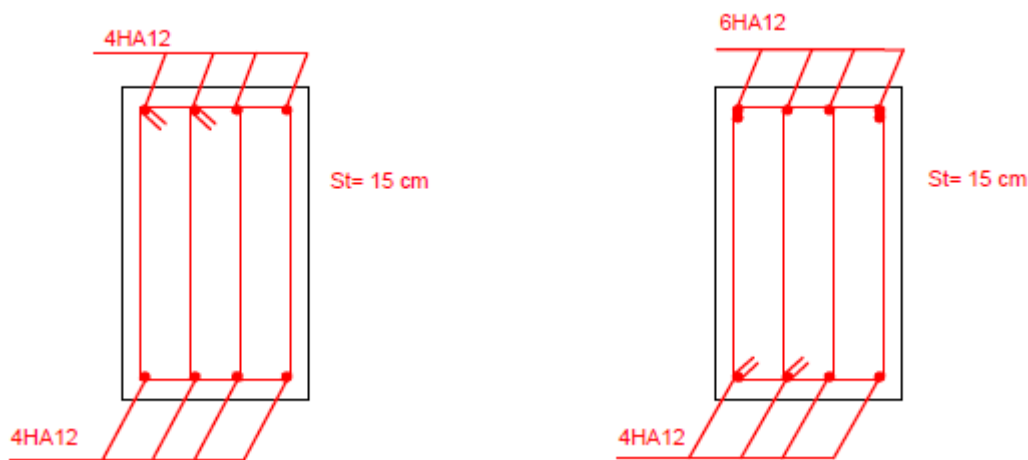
Schéma de ferrailage des poutres secondaires.
